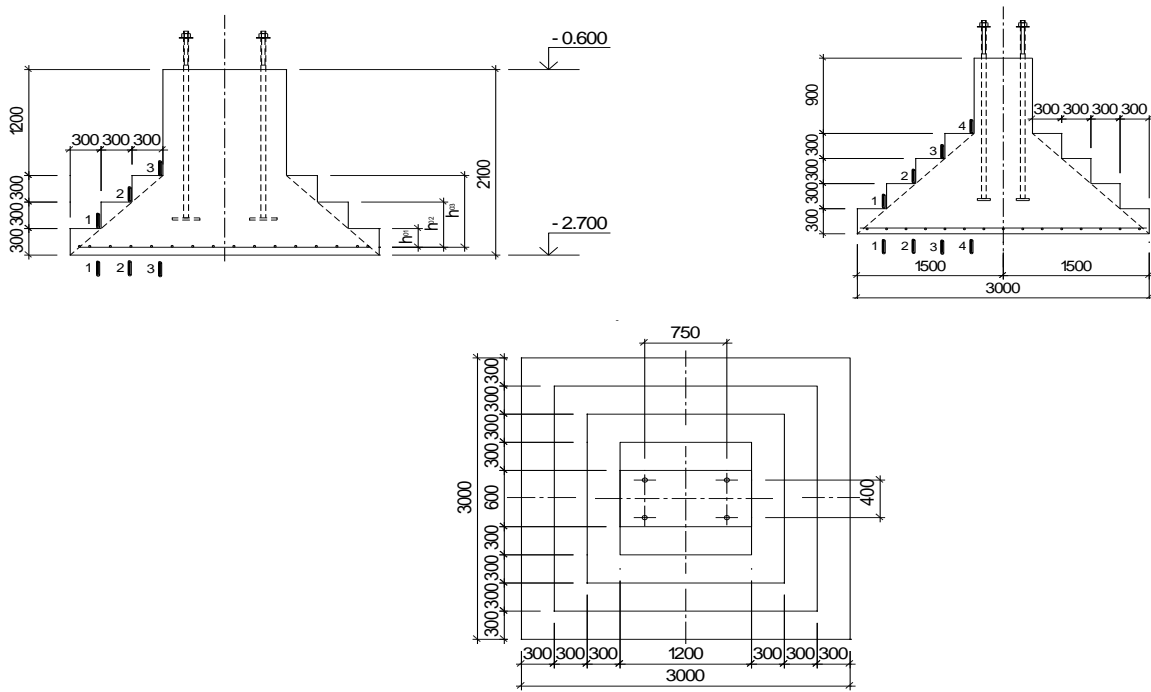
Схема підшови фундаменту до розрахунку арматури
